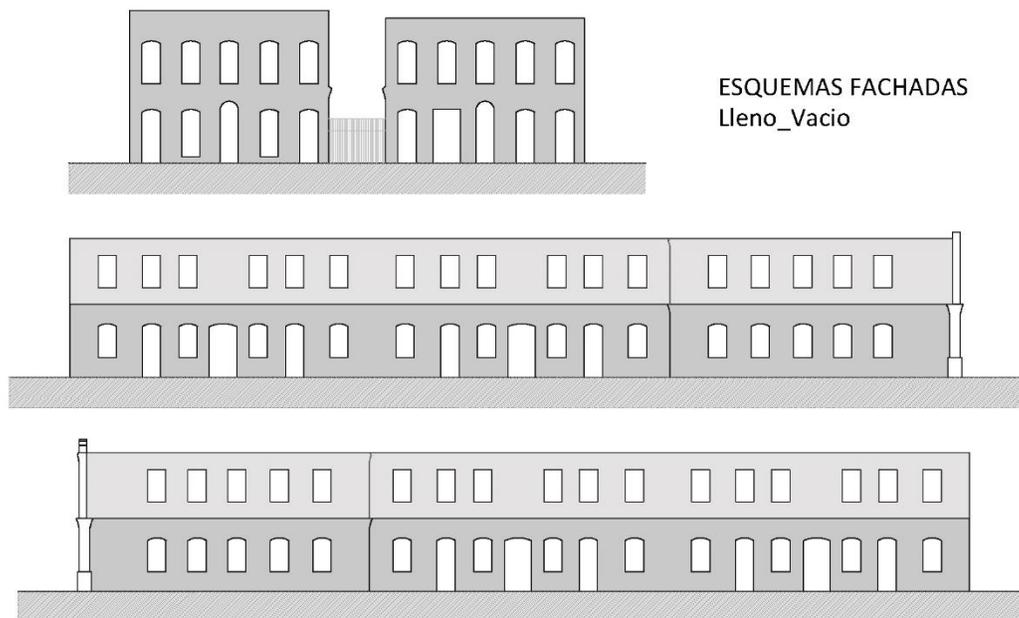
Esquema de fachadas consideradas para el cálculo de porcentajes.
